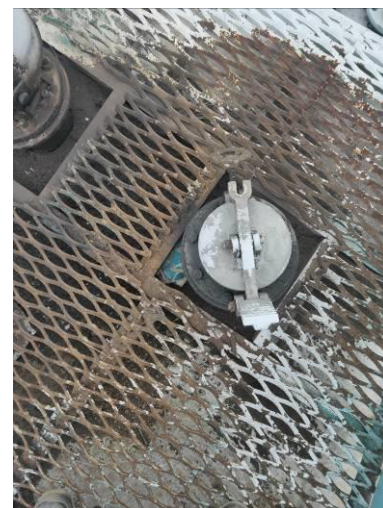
Общий вид резервуара РВС-700 (№455) с замерным люком
